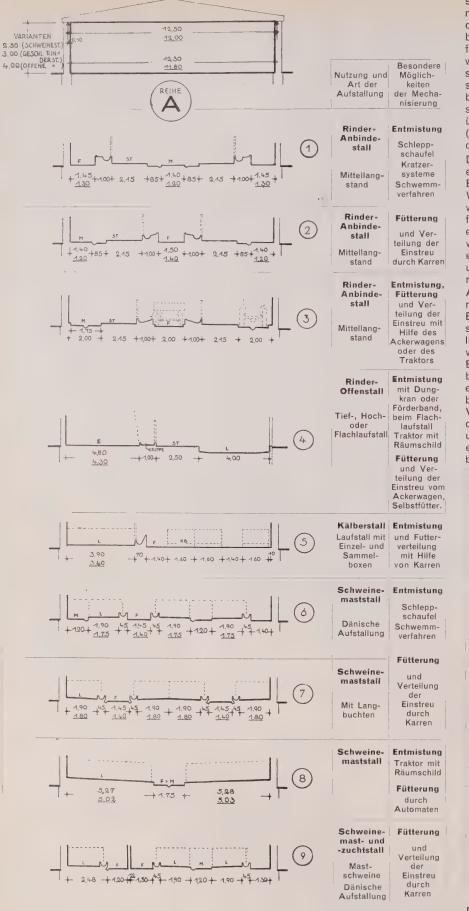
Zusammenstellung der erforderlichen Gebäudequerschnitte 1:800 1 Bauten mit Wärmedämmung — 2 Bauten ohne Wärmedämmung
